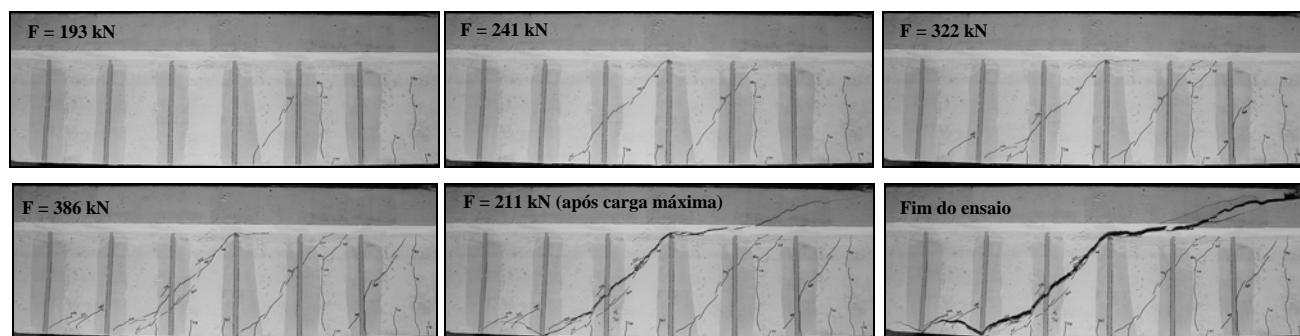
Fases do ensaio da viga 3S-6LV-D (carga máxima = 387.0 kN).
